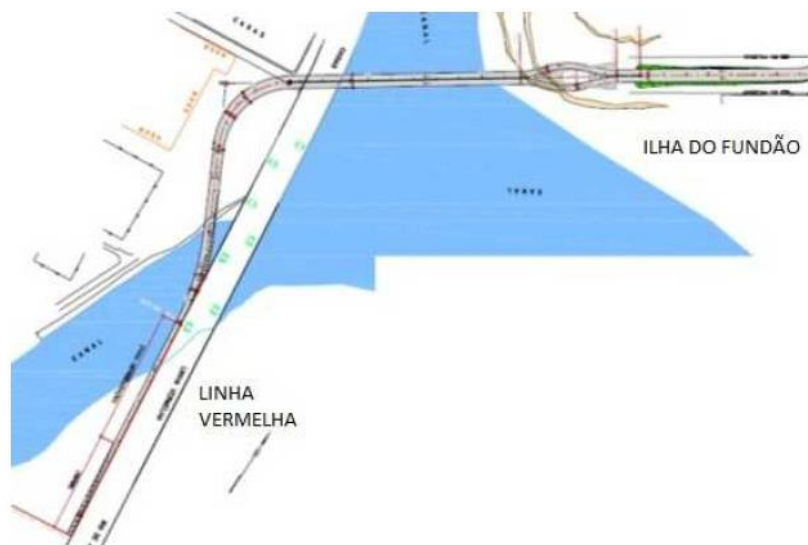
Planta de localização da Ponte do Saber. (GOMES, 2013)
